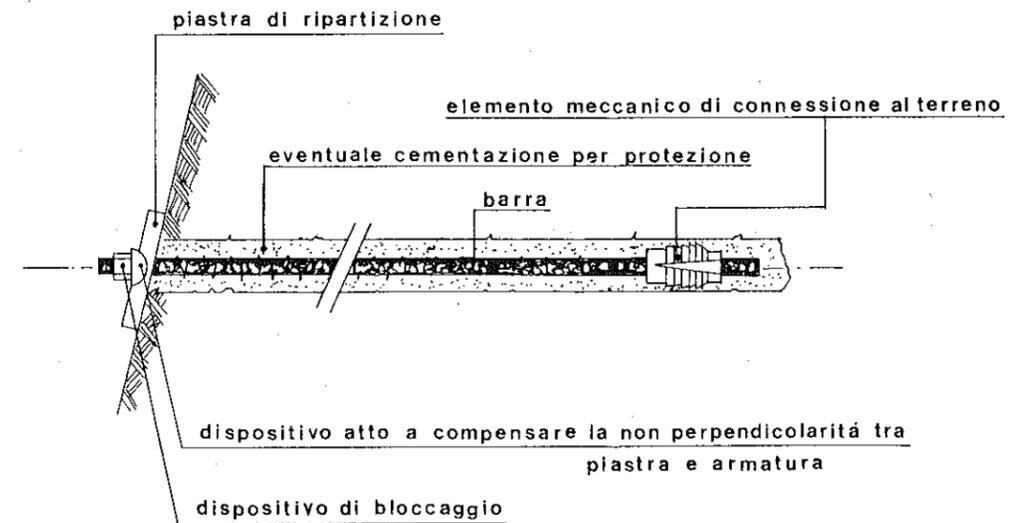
Bullone di ancoraggio: con ancoraggio ad espansione meccanica
